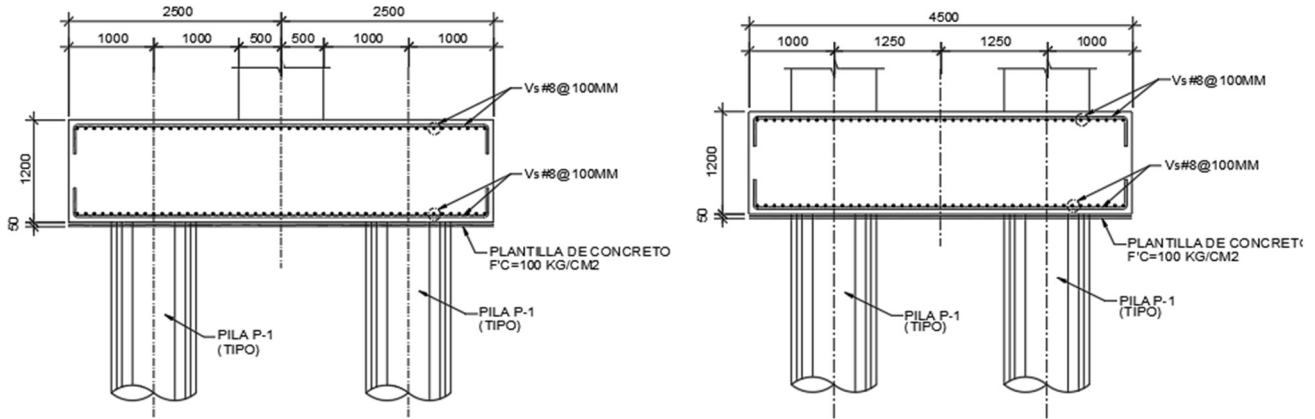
Dimensiones y armados propuestos de las zapatas Z-1, Z-2 y Z-3
